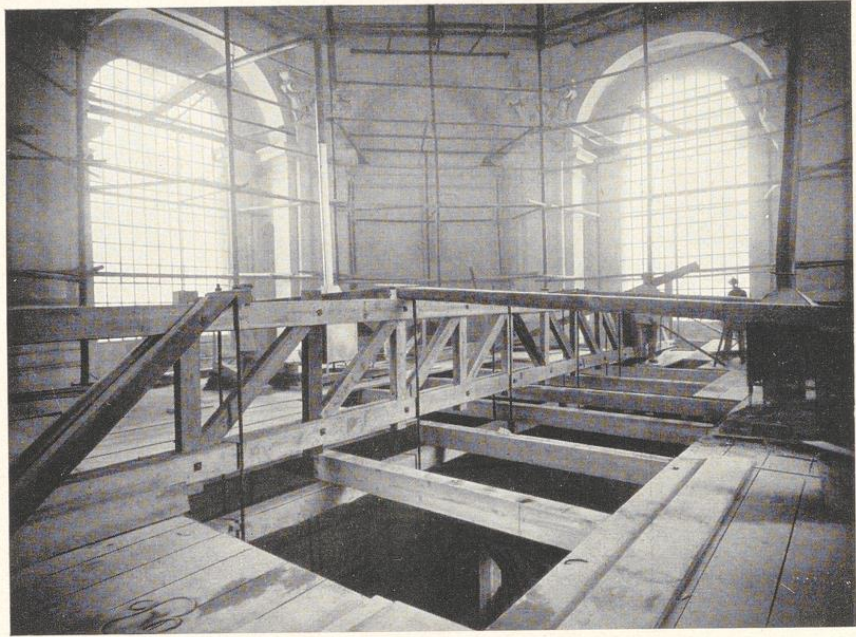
Freitragende Kirchenrüstung mit einer besonderen Binderkonstruktion.
